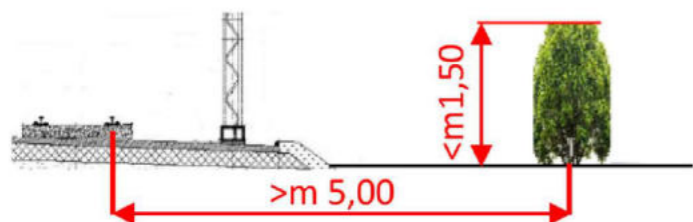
Distanza minima che deve esserci tra piante, siepi, muretti di cinta, steccati o recinzioni dalla rotaia più vicina se l'altezza di questi è inferiore a m 1,50
